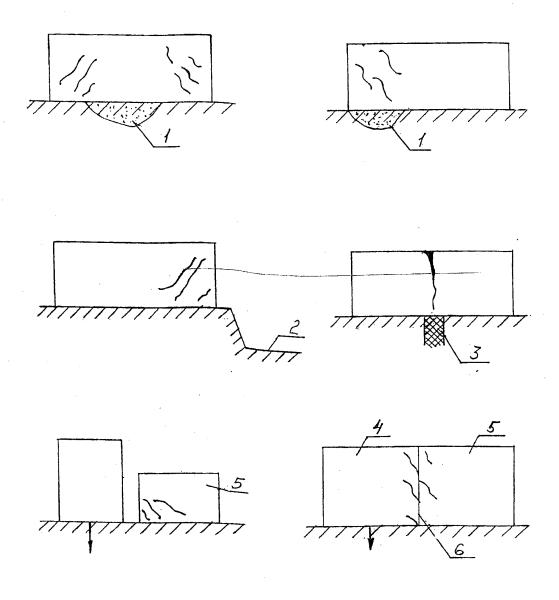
Характерные трещины в стенах зданий от осадки основания 1 - слабый грунт; 2 - котлован; 3 - жесткое включение значительных размеров; 4 - новое сооружение; 5 - старое сооружение; 6 - шов примыкания
